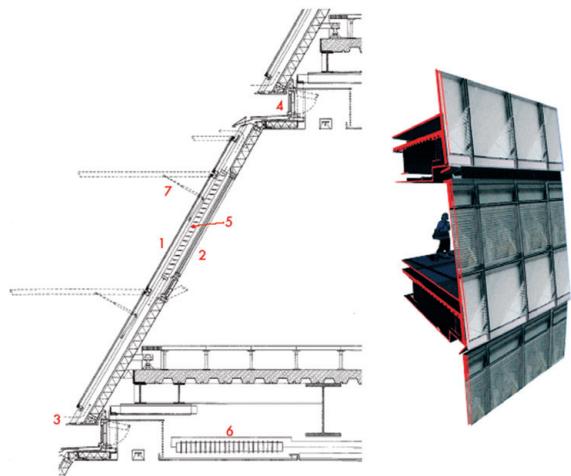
Схема конструкції північного фасаду будівлі мерії Лондону:
